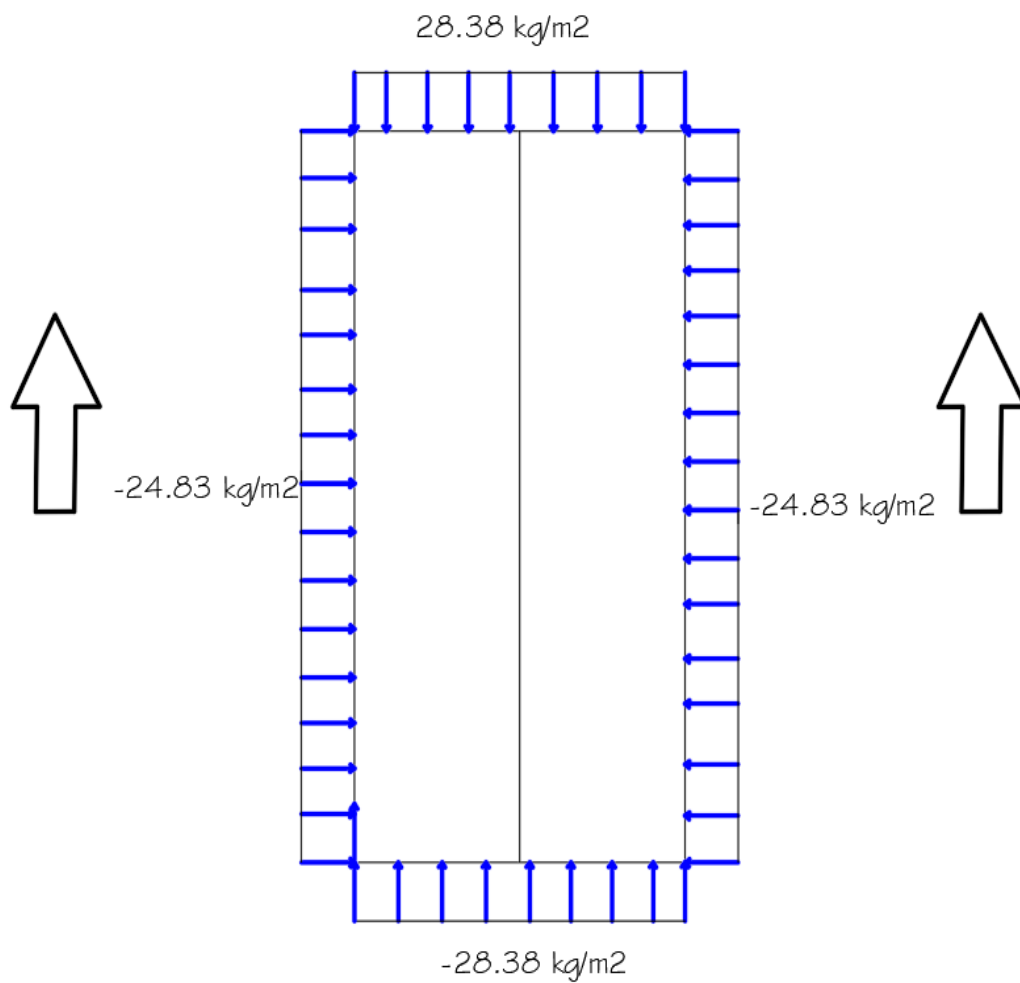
Tercer caso W_y : viento longitudinal o transversal a los pórticos, planta. Fuente Elaboración propia.
